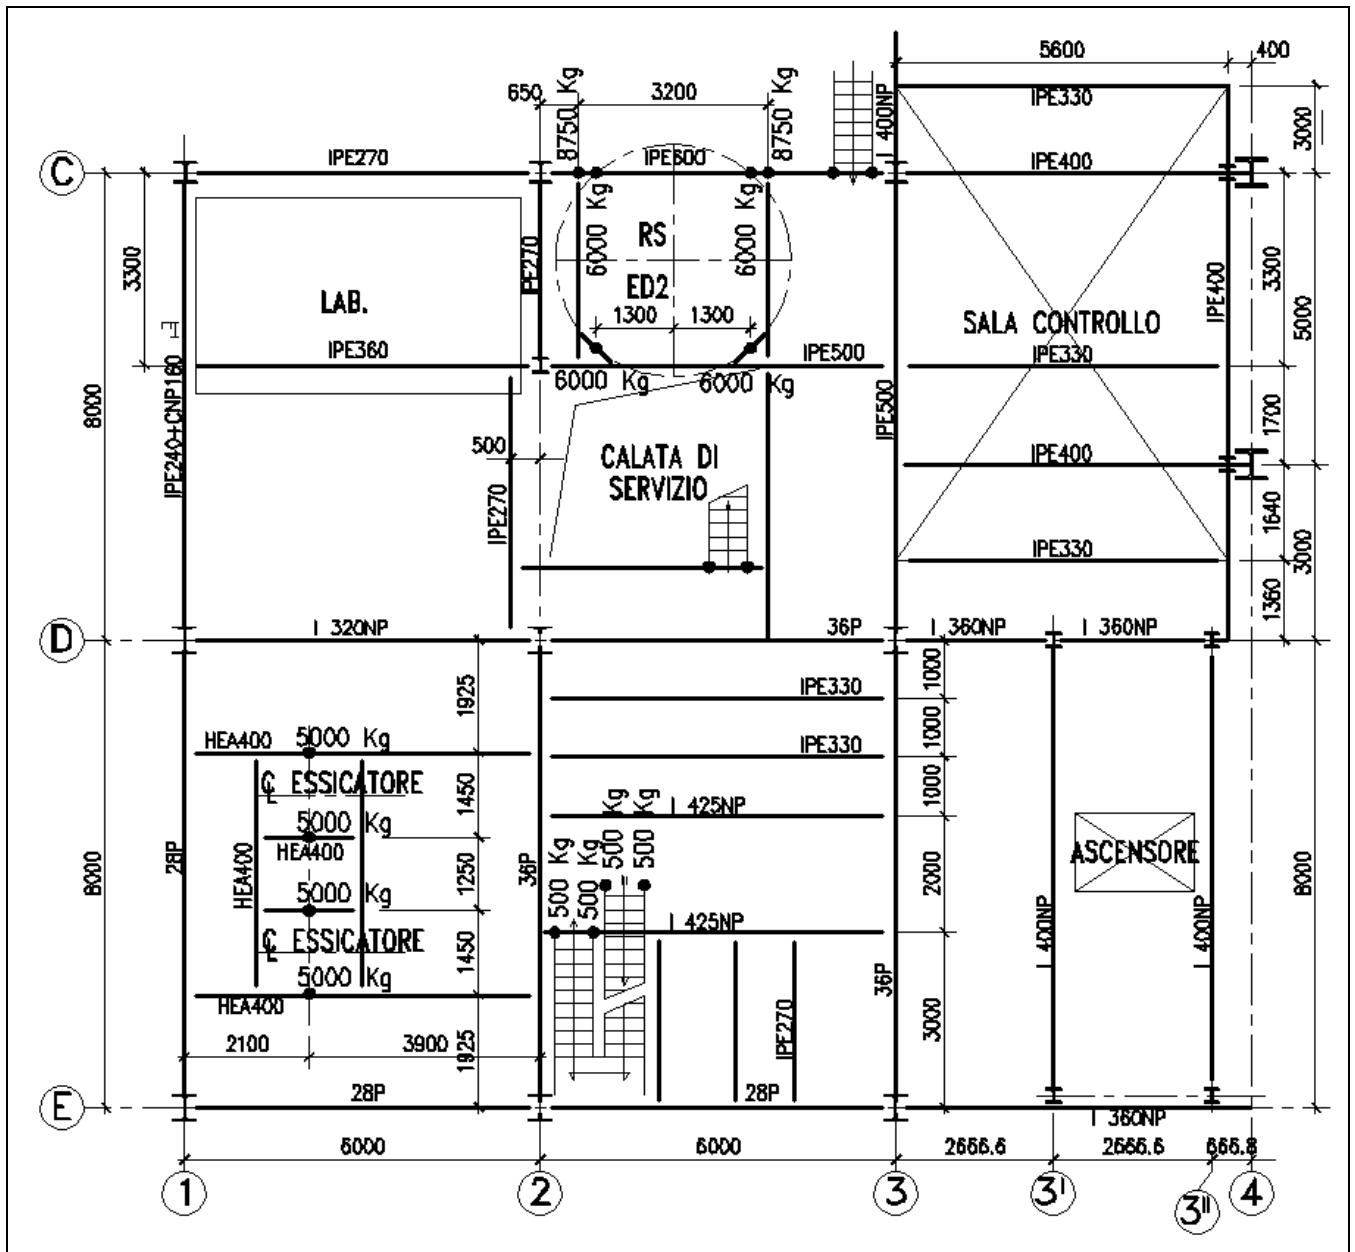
PLANIMETRIA +12.500 - primo impalcato -
